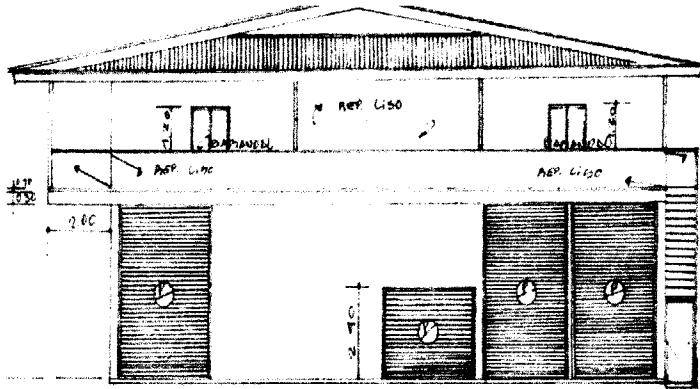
Plano de vista frontal del proyecto Construcción de Depósito
